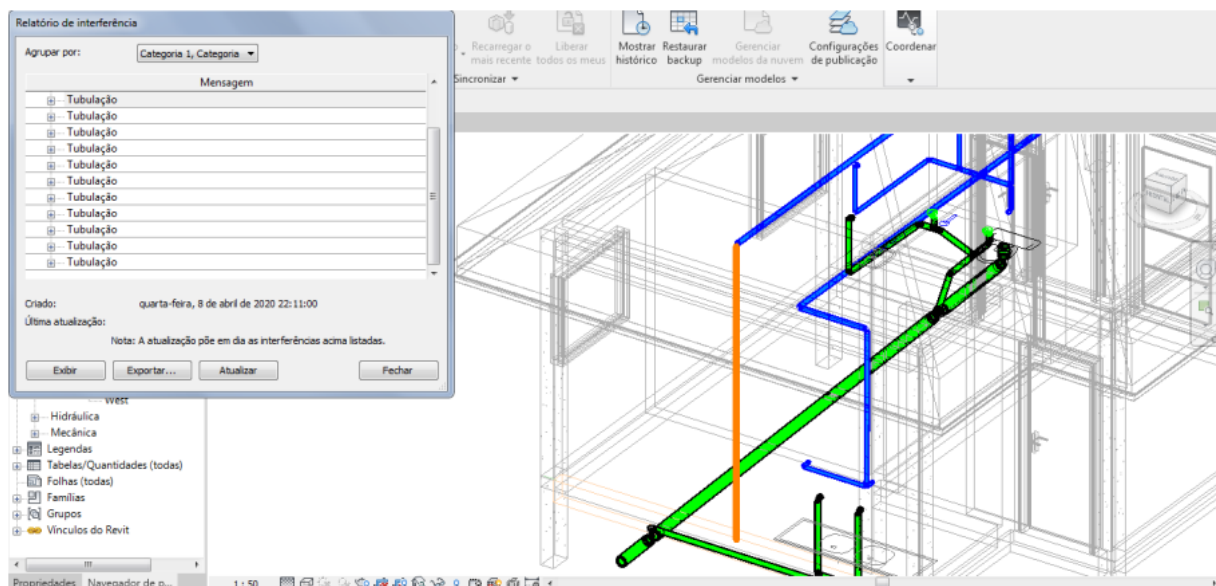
Interferência entre a viga de fundação e a viga da laje com a tubulação de água. Fonte: Resende et al., 2020
